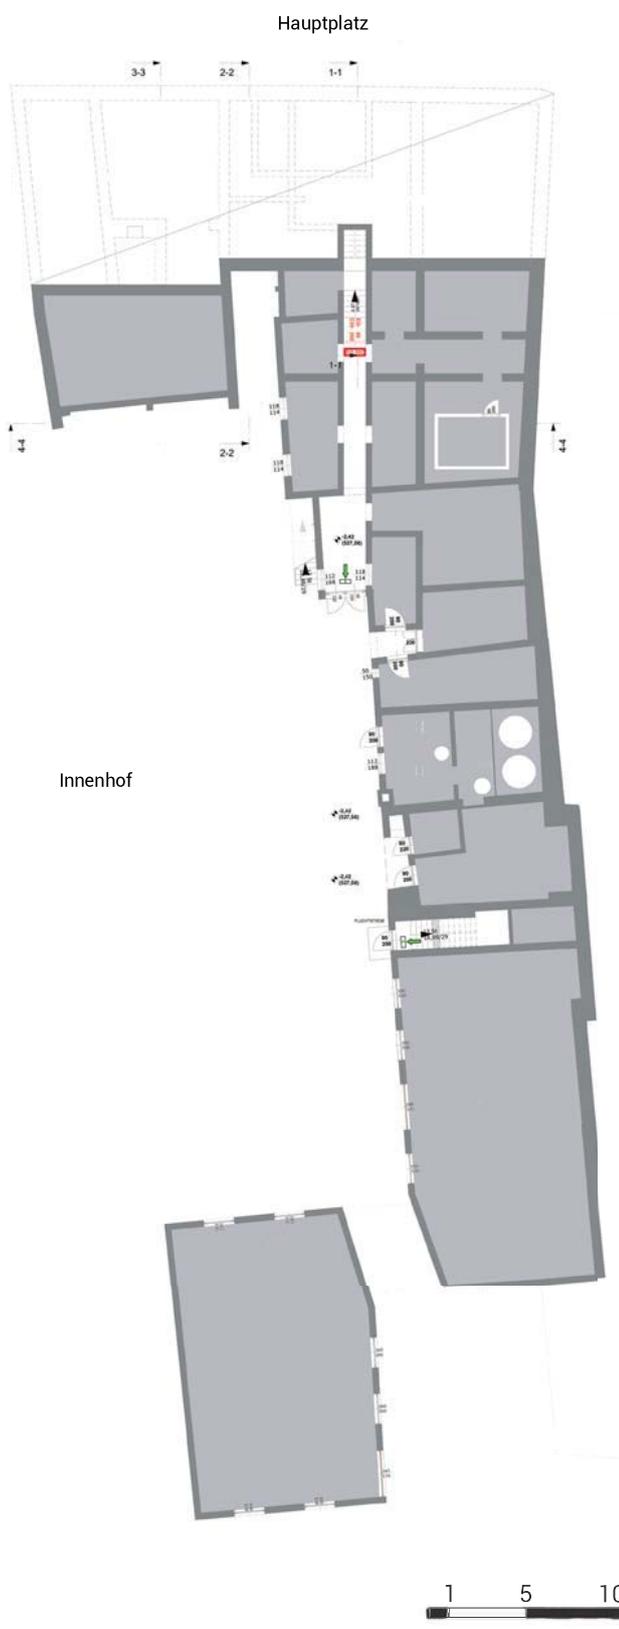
Grundriss Untergeschoss Hotel zur Sonne
